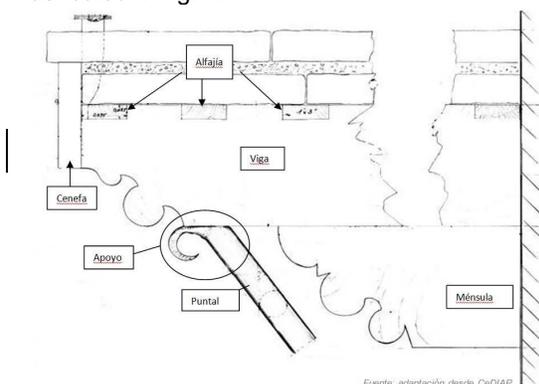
detalle constructivo^[1]. Adaptado CeDIAP
